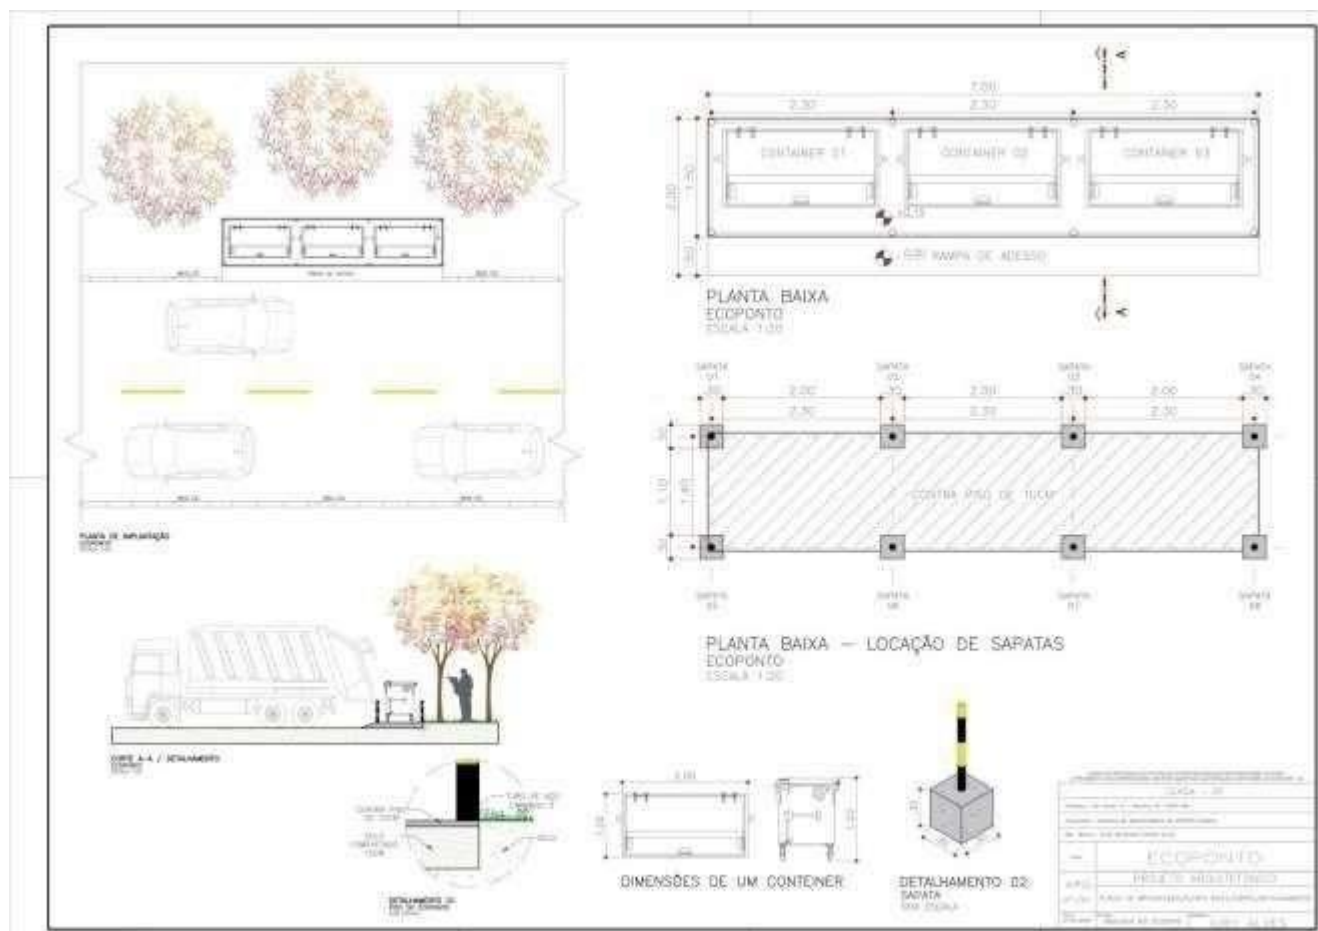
Planta baixa de Eco ponto na CEASA-DF que comporta 03 contêineres.
